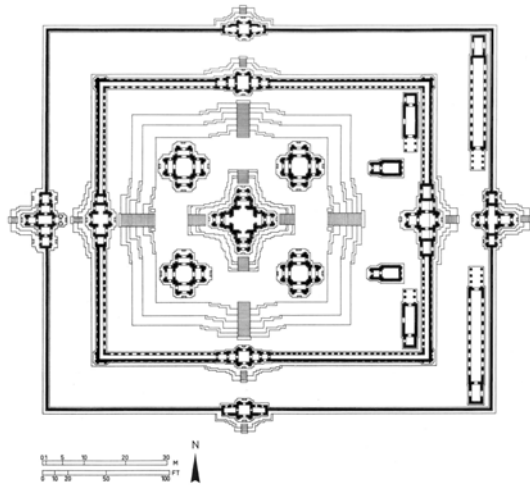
Grundriss Ta Keo/Angkor
